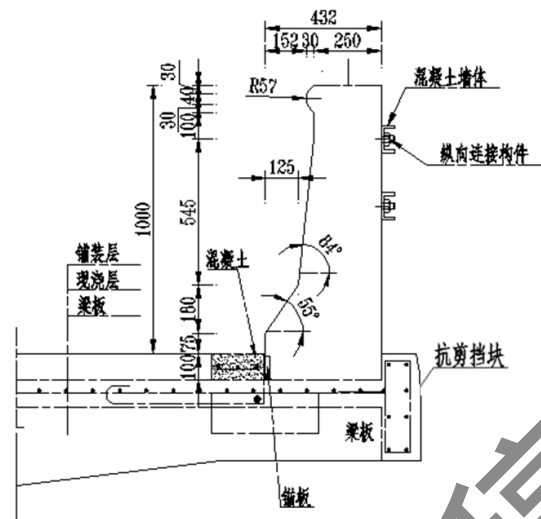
五（SA）级桥梁混凝土永久护栏设置示例（单位：mm）
